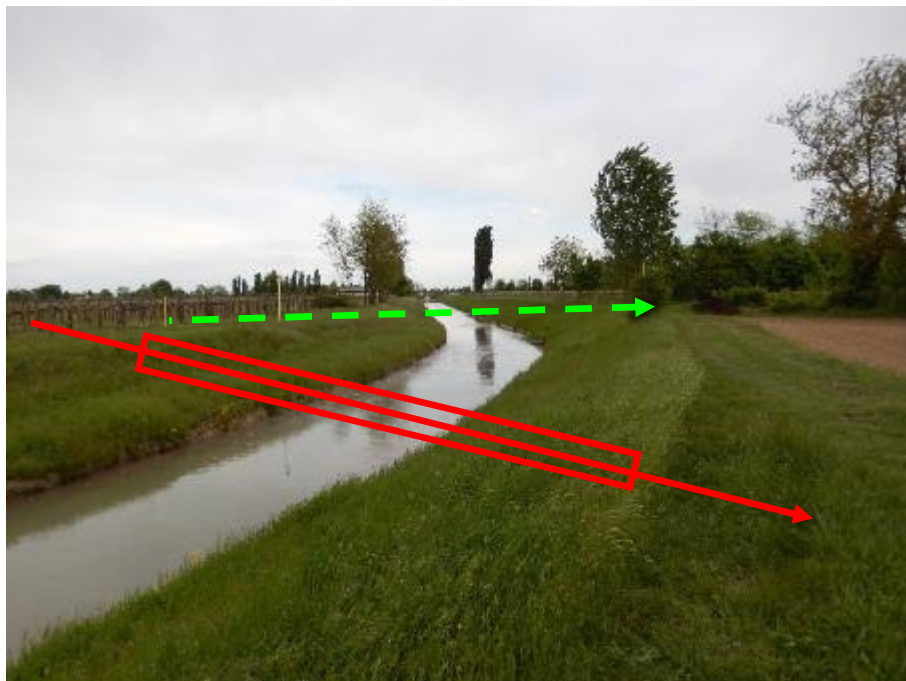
ATTRAVERSAMENTO CANALE GRASSAGA
